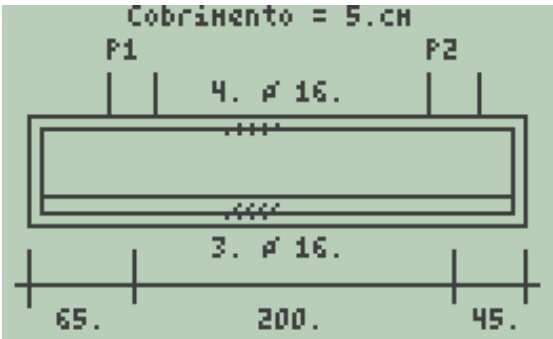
Sapatas Associadas - Detalhamento da viga, armaduras.
